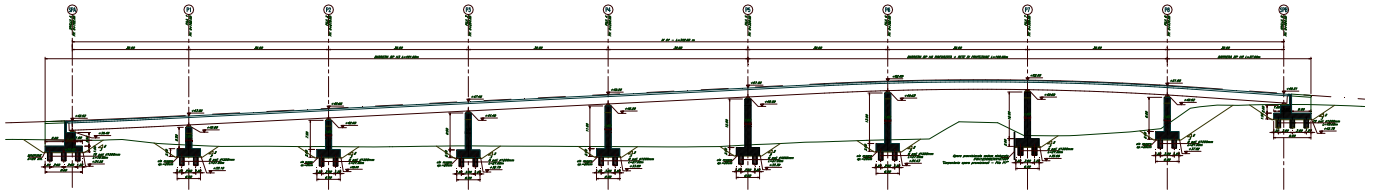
Profilo longitudinale e planimetria e dell'impalcato
